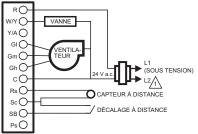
Schéma de câblage à deux conduits pour chauffage seulement (24 V c.a. illustré).
